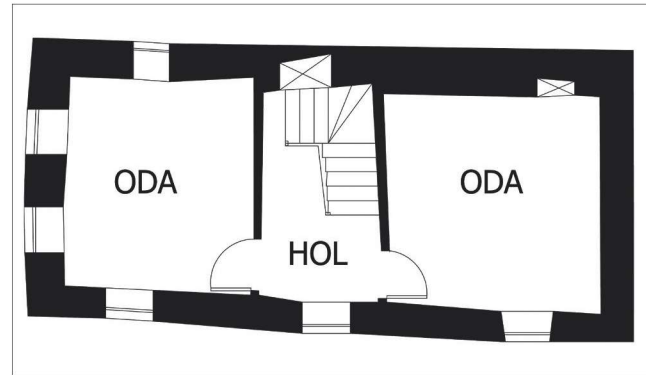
819 Parsel, Bodrum Kat / Building lot: 819, basement floor plan.
